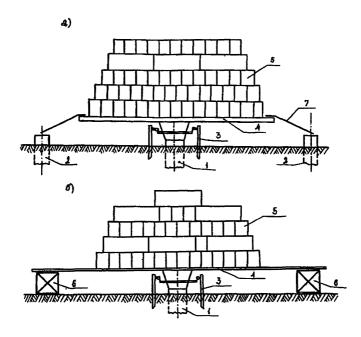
Схеми установок с тарированным грузом: а — установка с анкерными сваями; б — установка с опорами; І — испытываемая свая; 2 — анкерная свая; 3 — реперная система с прогибомерами; 4 — грузовая платформа; 5 — тарированный груз; 6 опора; 7 — металимуеский тяж
